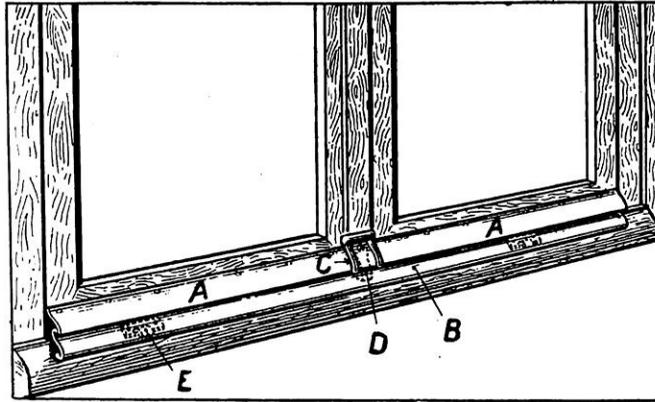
VUE D'ENSEMBLE DU NOUVEAU JET D'EAU POUR FENÊTRE
